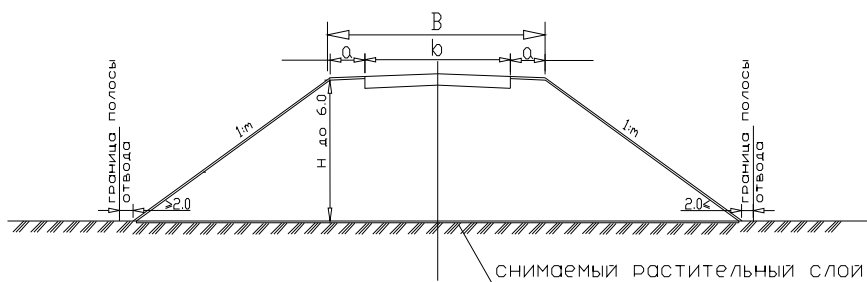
Поперечный профиль насыпи с высотой откоса до 6 м
